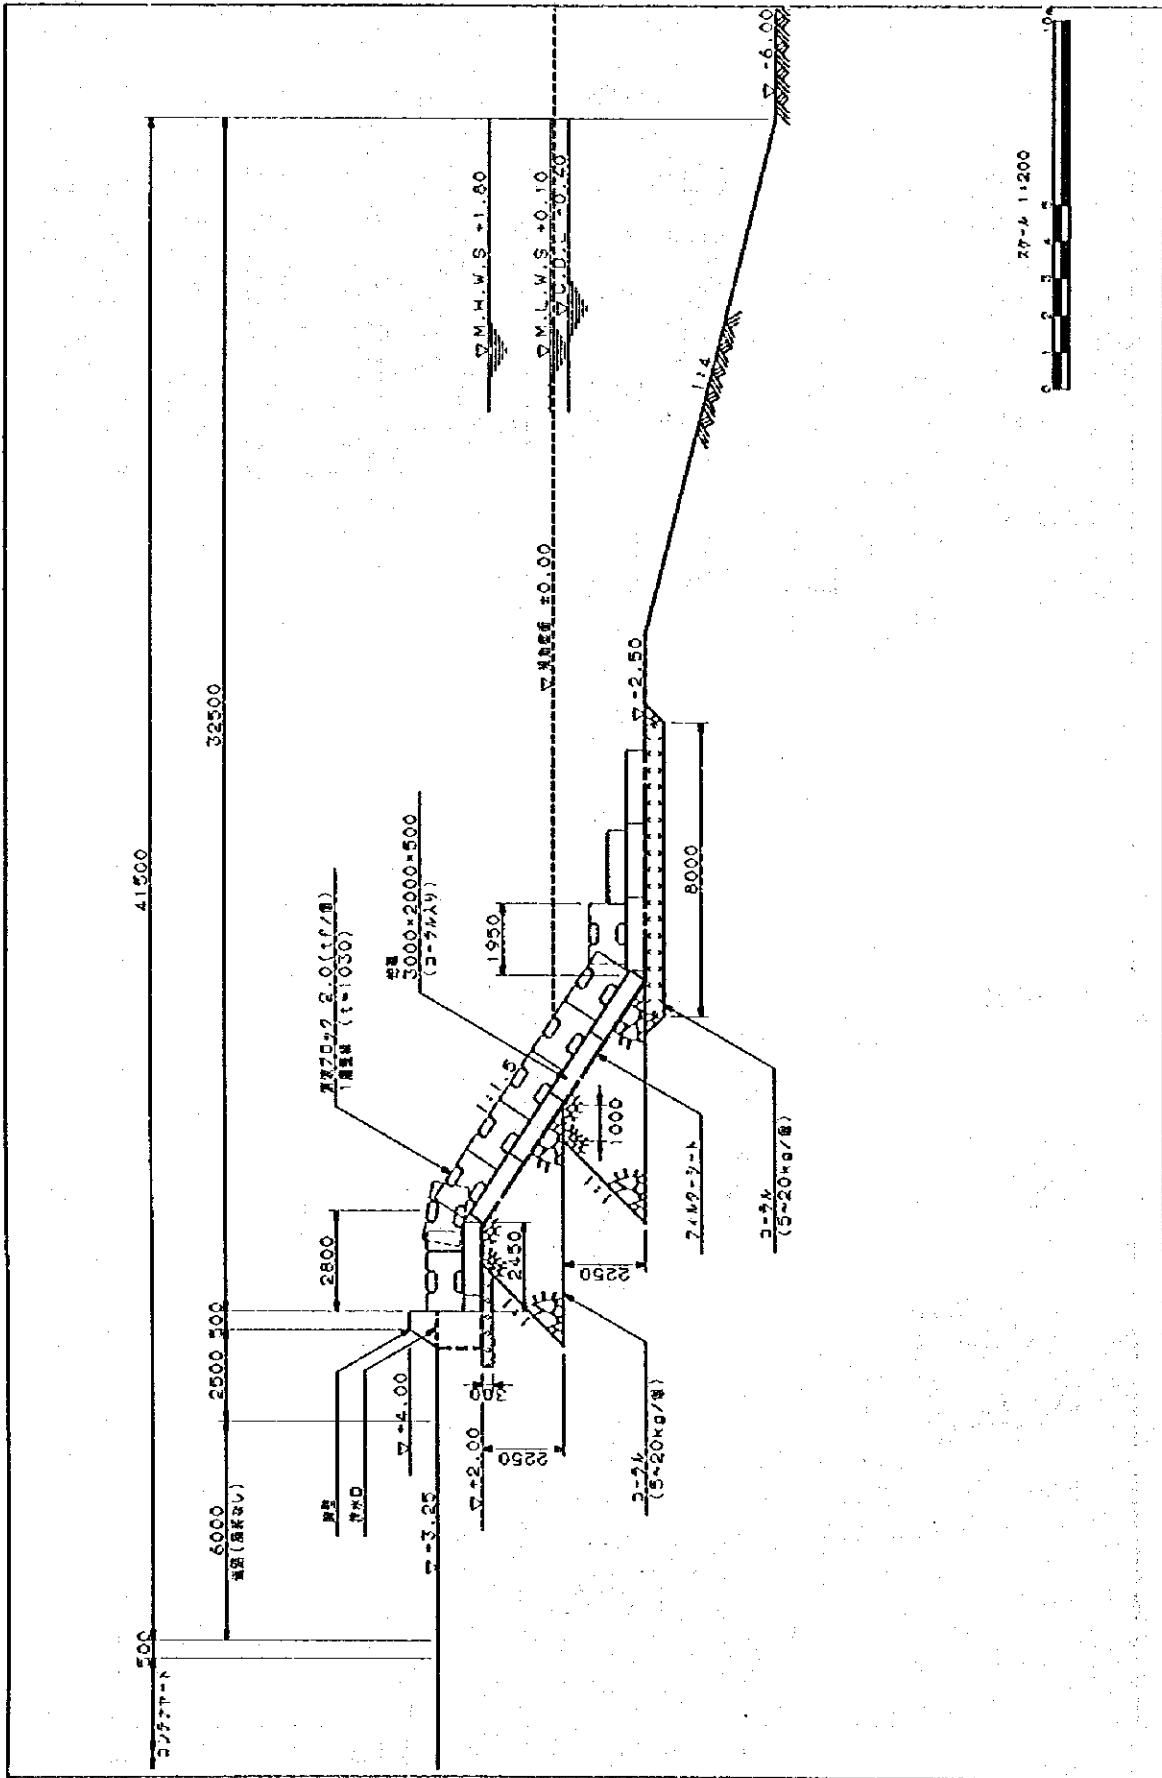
(1) 泊地護岸標準断面図(隅角部)
